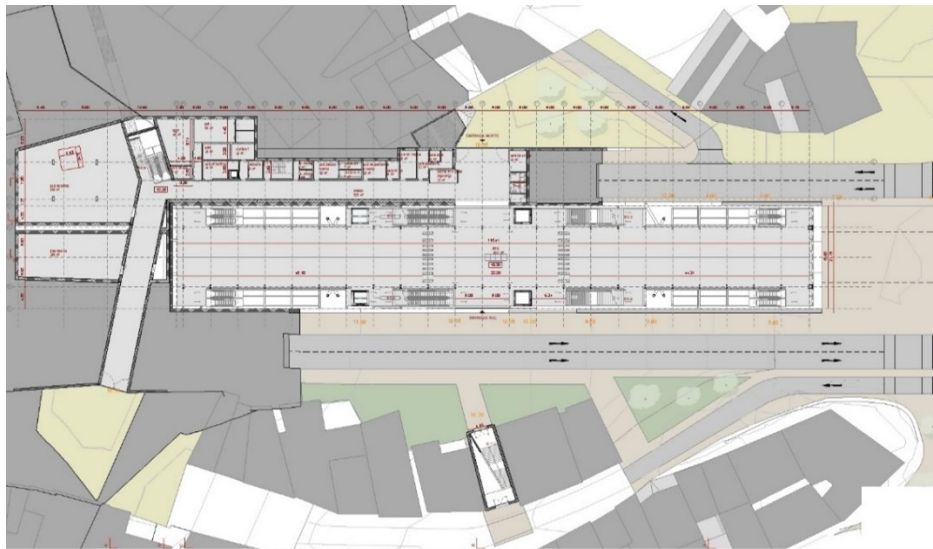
Planta Piso 0 - Átrio (ML 134352)
